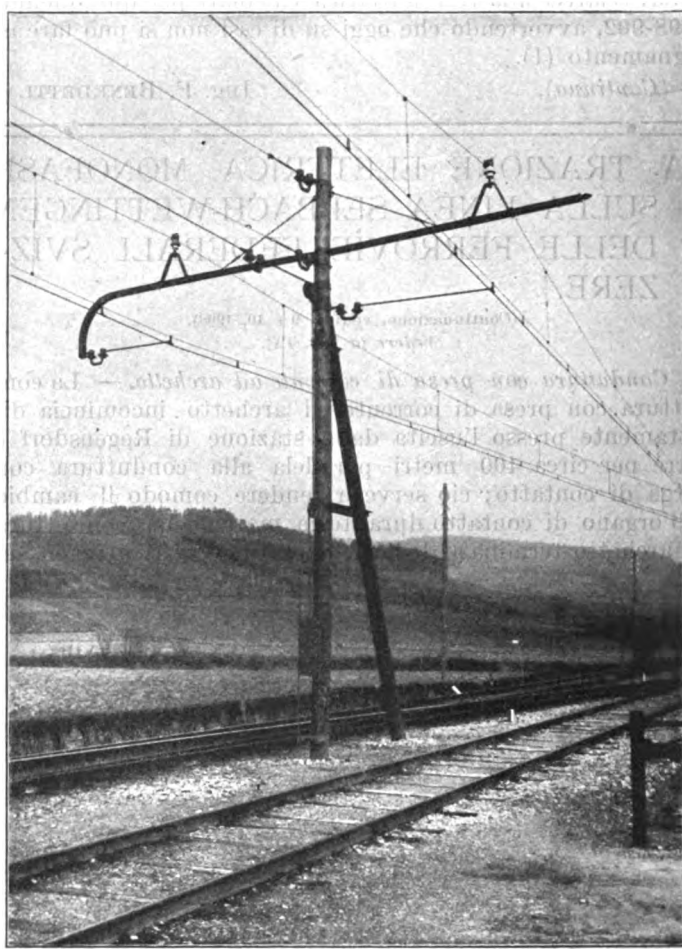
Palo a cavalletto con due bracci e dispositivo tenditore automatico per filo di contatto.
